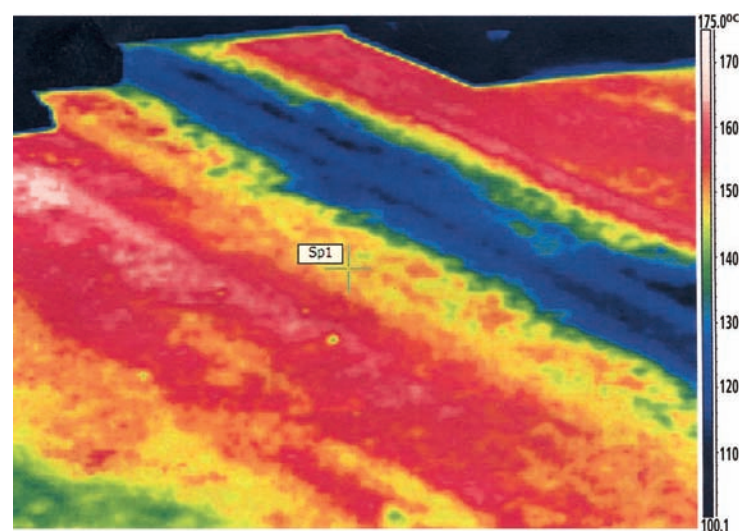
Trainée thermique longitudinale derrière le finisseur. Site potentiel de fissuration longitudinale.
